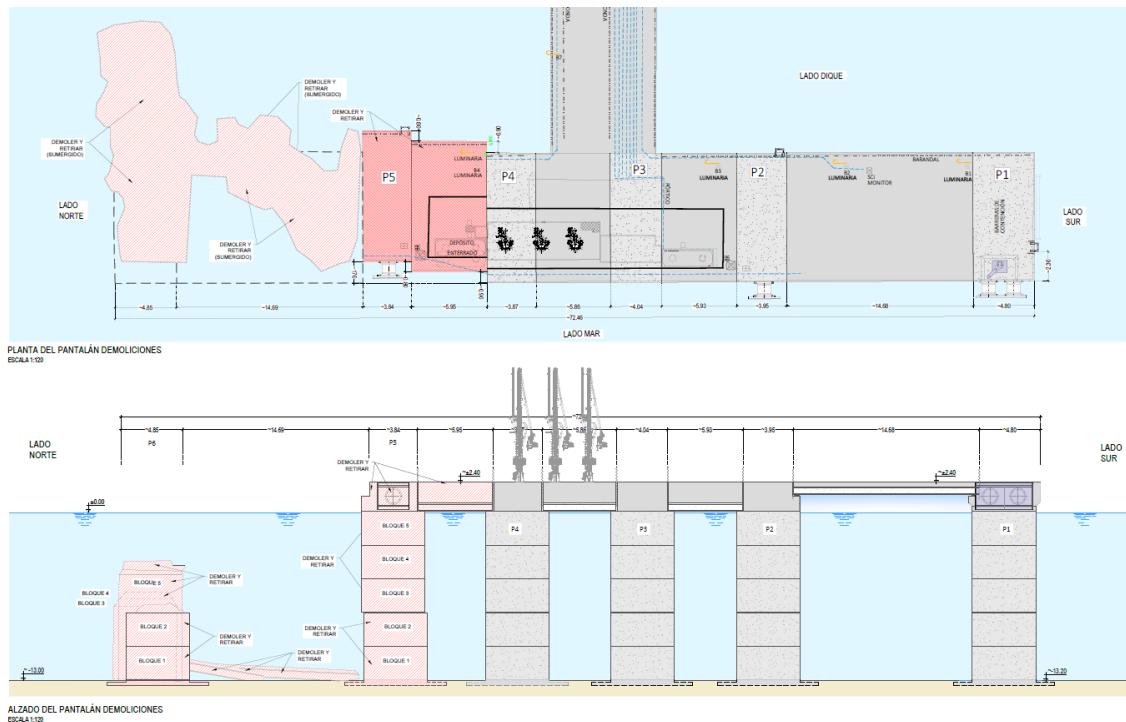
Planta y alzado de la obra civil afectada por el accidente
